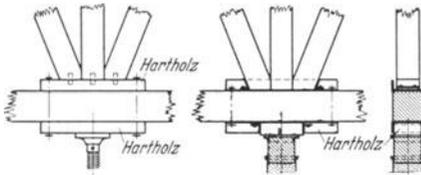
Auflagerknotenpunkt in einem Lehrgerüst. Einschaltung von Hartholz- oder U-Stahlstücken (nach Mörsch 10b).
